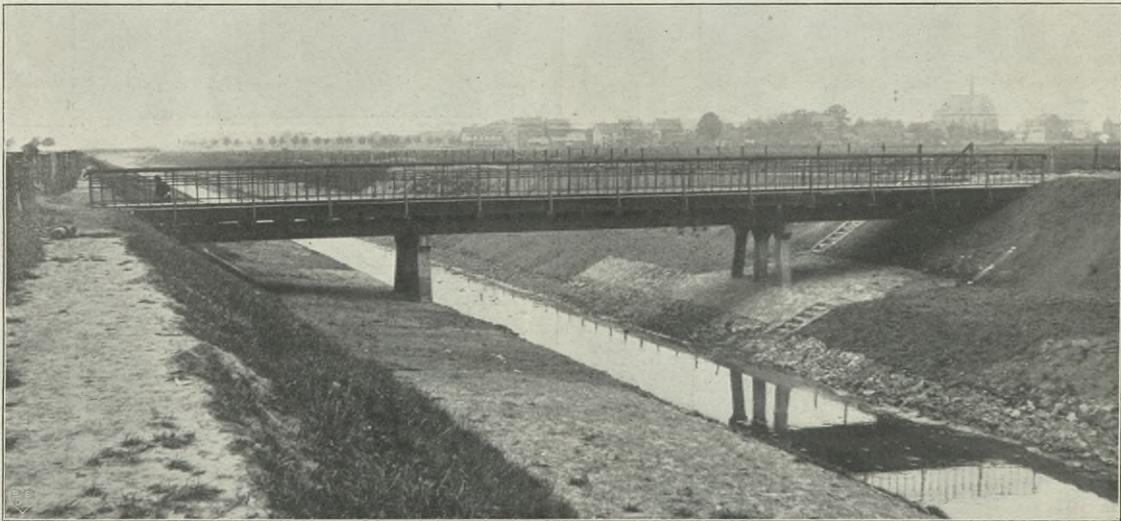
Wirtschaftsbrücke bei Henrichenburg. Der Unterbau besteht aus Eisenbetonpfahl-Jochen mit einem Eisenbeton-Holm; die Joche konnten unbedenklich innerhalb des Hochwasserdurchfluß-Querschnitts angeordnet werden. Es entstanden so drei Oeffnungen, die mit eisernen Trägern überbaut sind.
